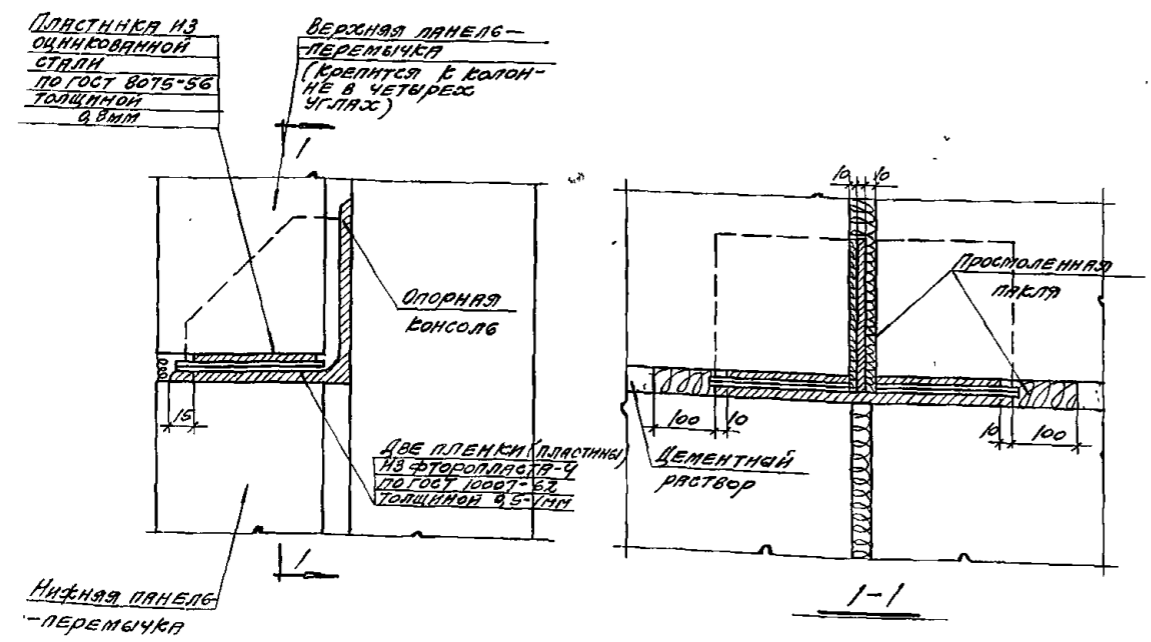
Температурный шов в продольных навесных панельных стенах на одной колонне (крепление панелей к колоннам условно не показано).
